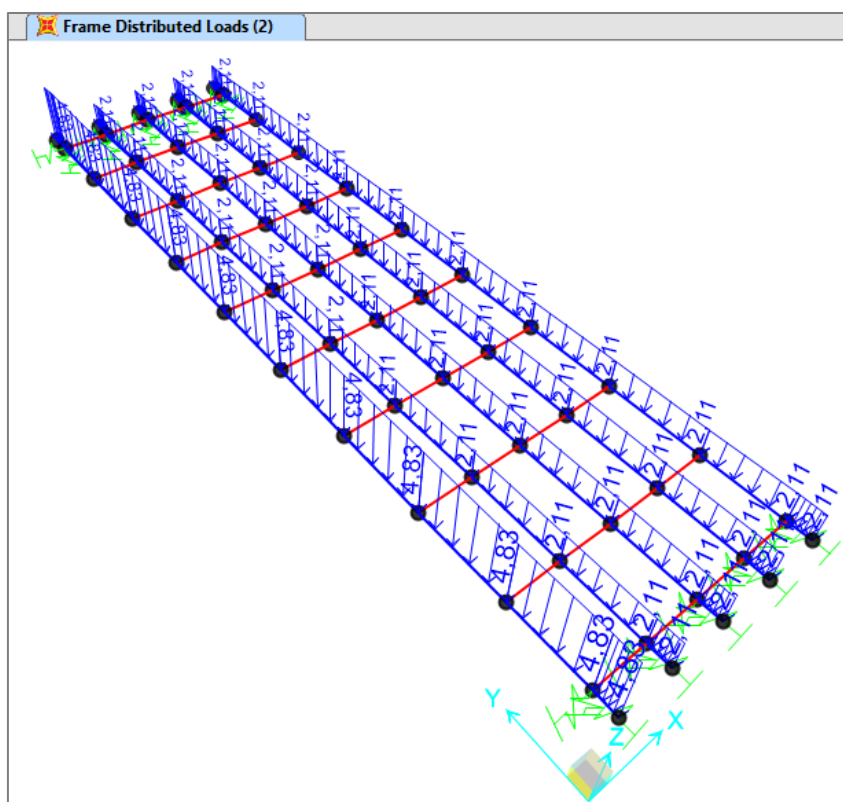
Carichi permanenti dovuti alla pavimentazione e agli arredi stradali.
